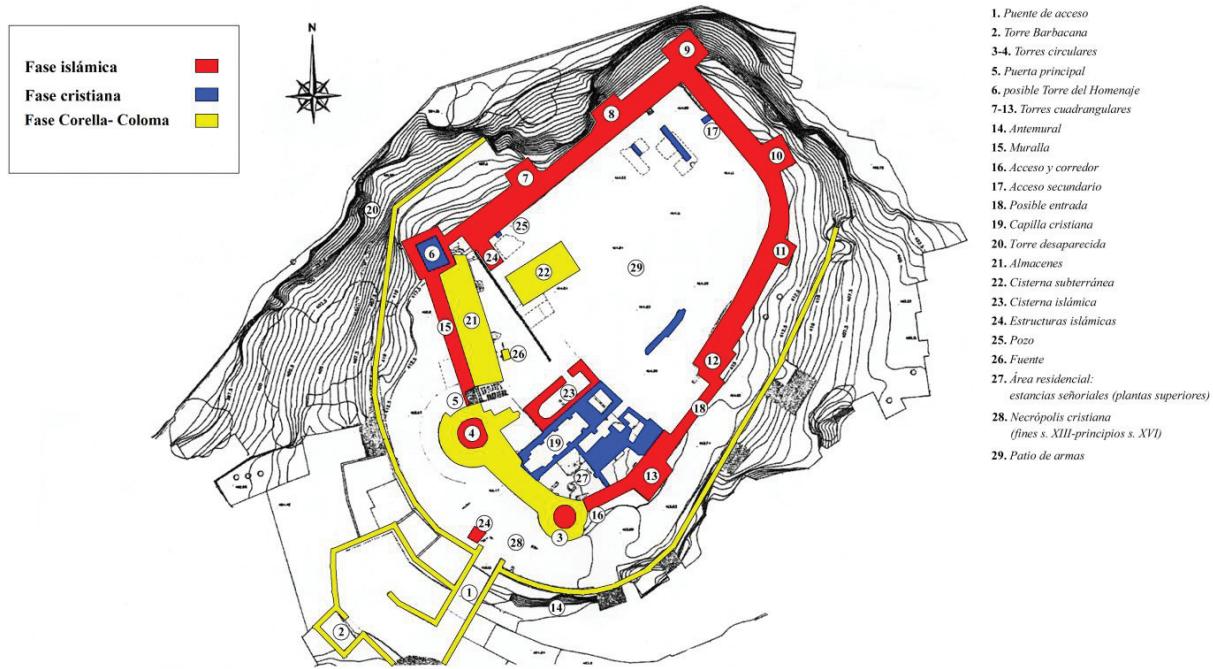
Plano por fases. Fuente: Ayuntamiento de Elda (Sánchez-Márquez-Poveda, 2003).
